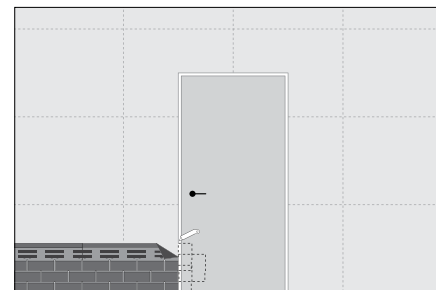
Монтаж фасадной плитки вокруг дверных проемов
